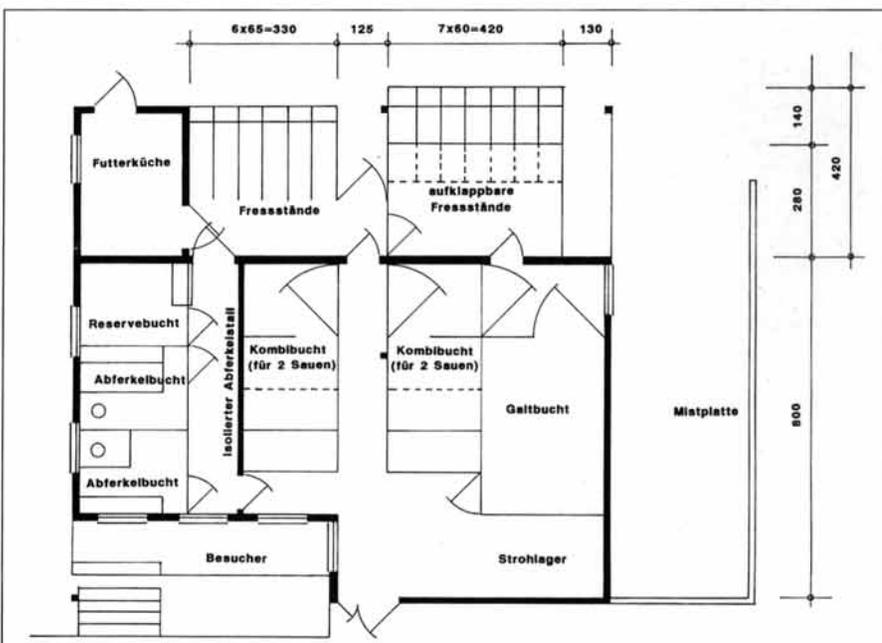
Grundriss des verwendeten Kaltstalles
